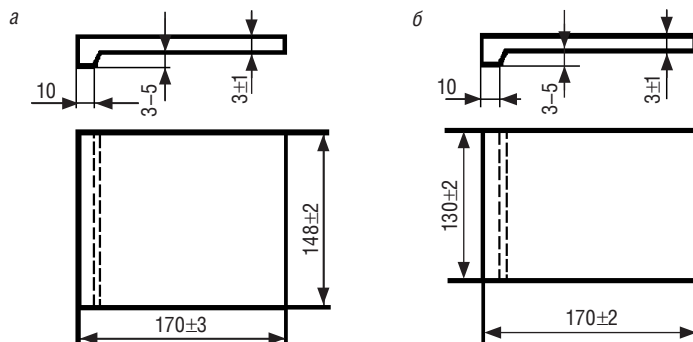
Регулировочные прокладки для железобетонных шпал при раздельном скреплении:
